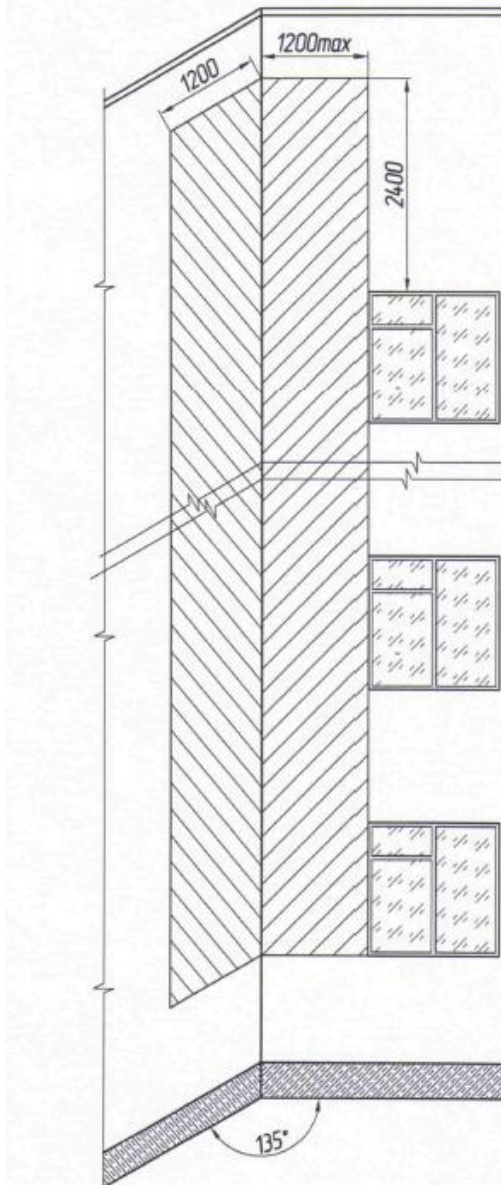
участки фасада с особыми требованиями к монтажу системы по пожарной безопасности.
